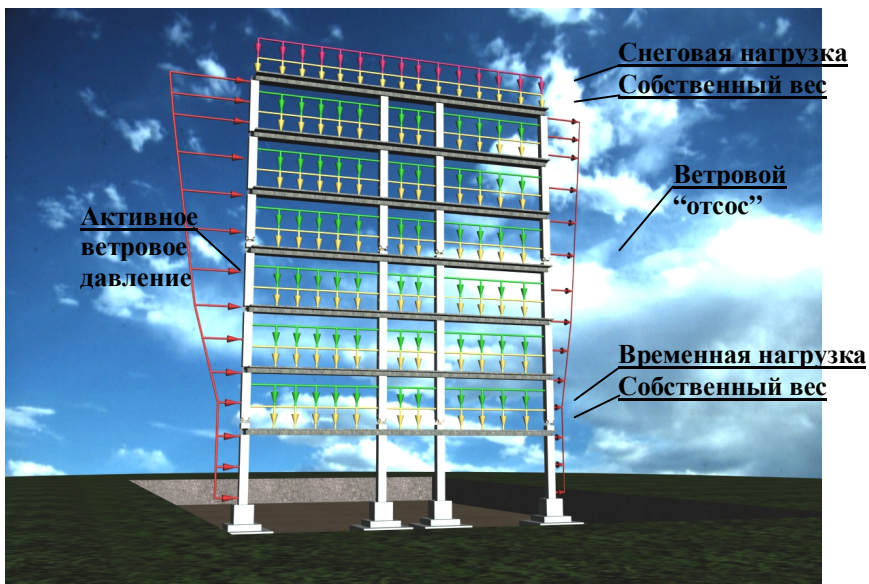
Расчетная схема поперечной рамы каркаса
